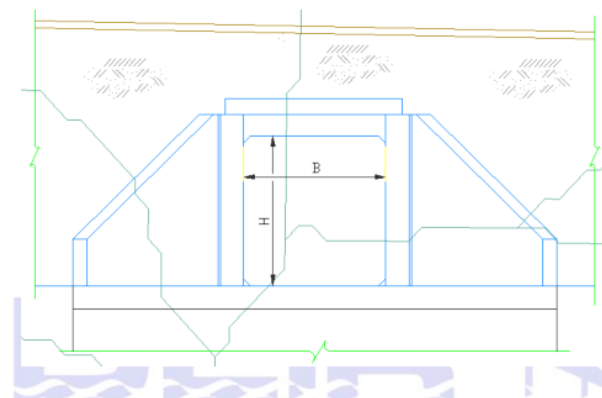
Estructura geométrica rectangular para las alcantarillas pluviales
